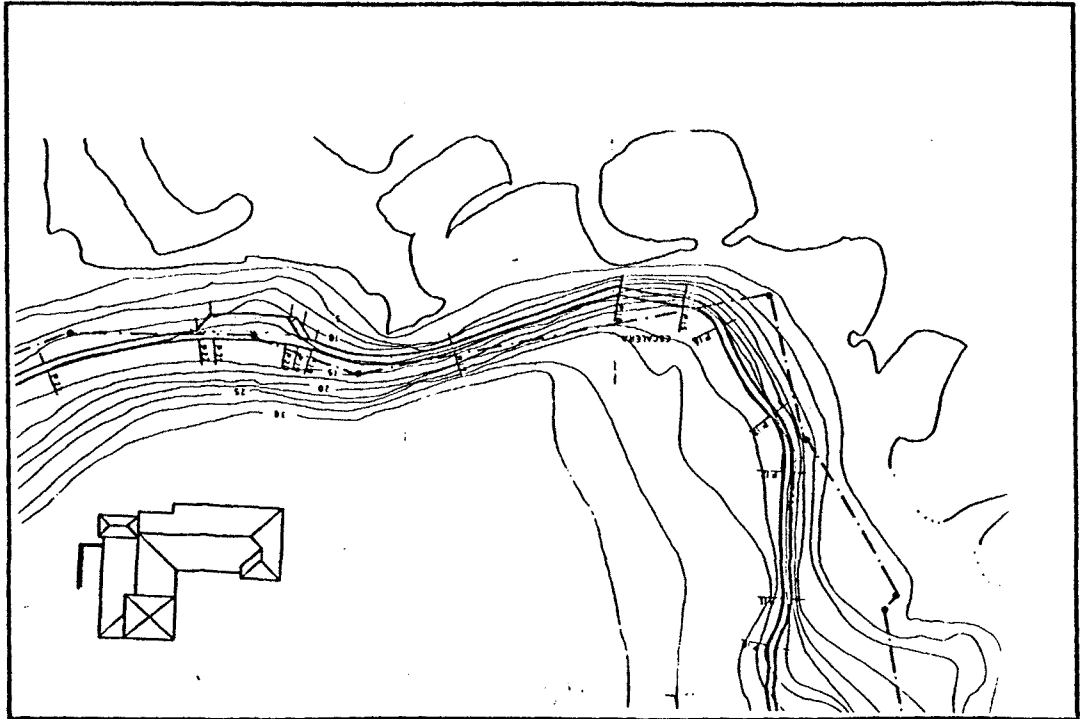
Plànol de la planta d'un fragment de la proposta de C.R.. Pla Parcial de Santa Clotilde. Lloret de Mar.
